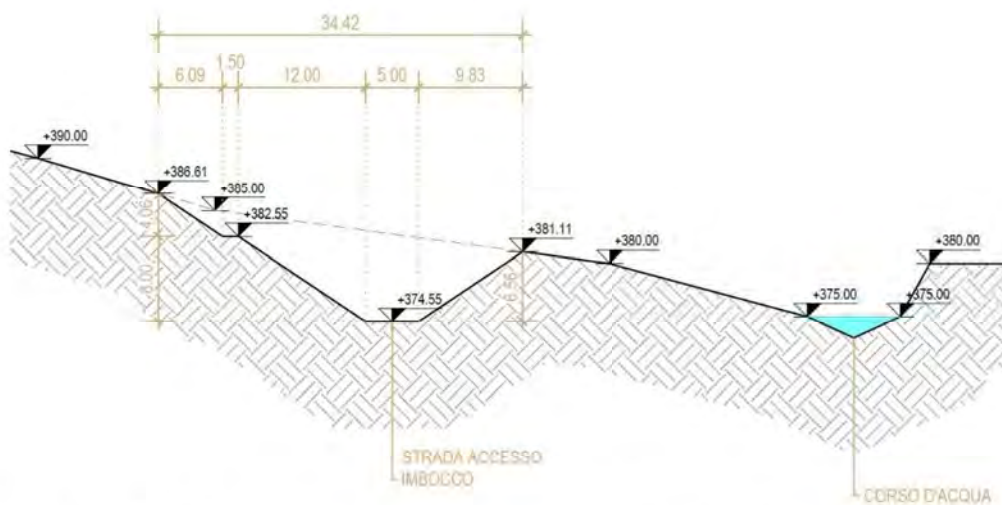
Profilo terreno. Sezione sulla strada di accesso all'imbocco galleria (Discenderia).
